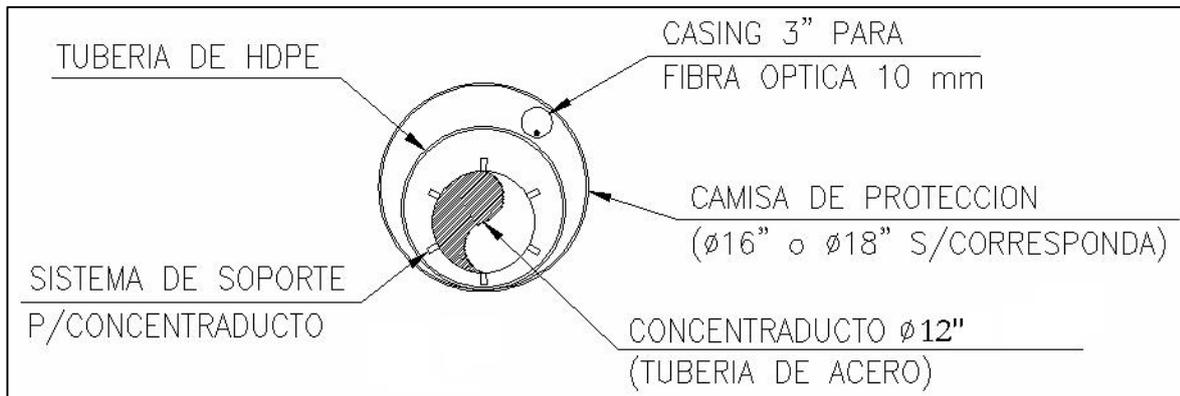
Cruce Tipo 1 – Sección de Cruce Camino Pavimentado
